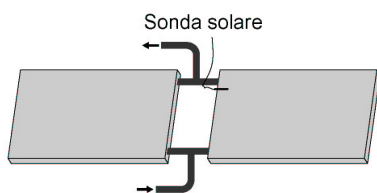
Collegamento parallelo di 2 x Helio Plan 2.2, orientati orizzontalmente
